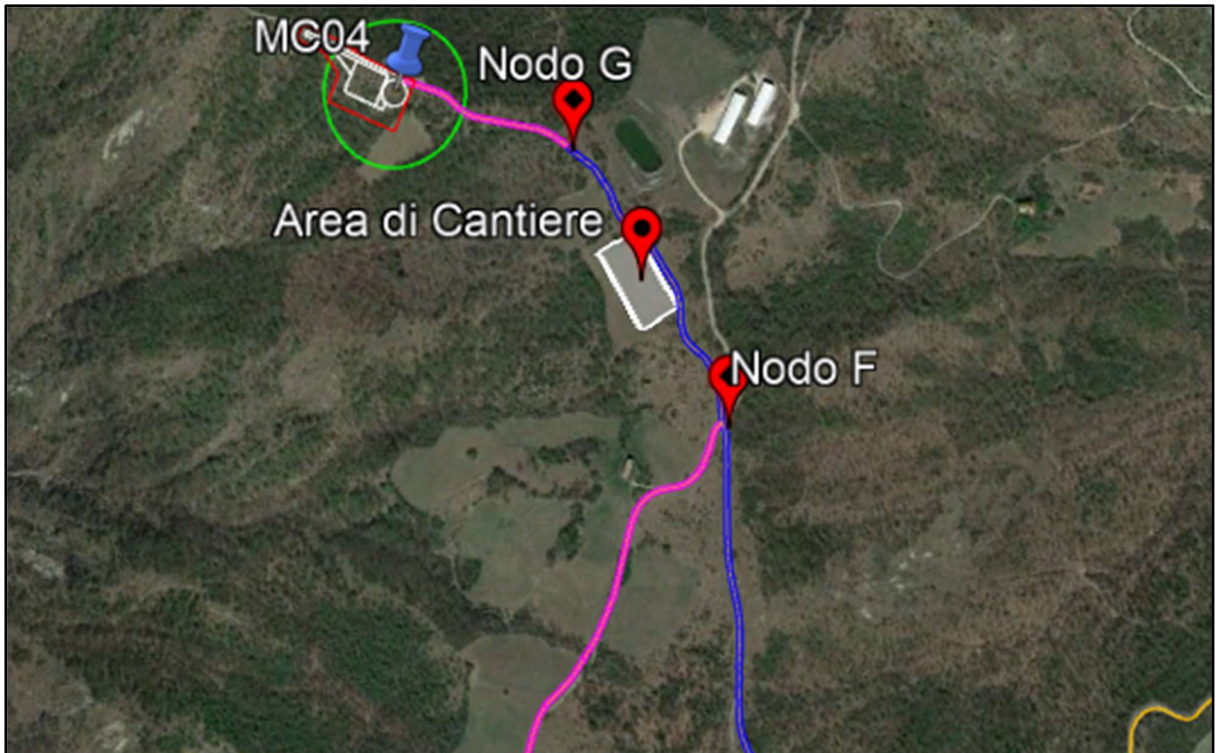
Planimetria interventi continui di adeguamento ipotizzati su strade esistenti
